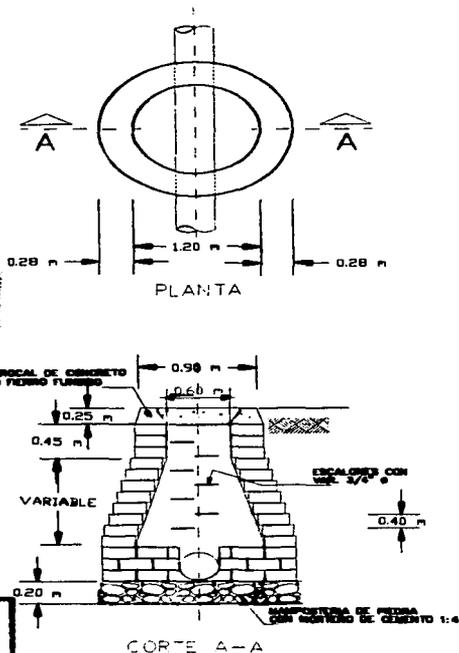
"Detalles constructivos de pozo de visita de la red de alcantarillado"
